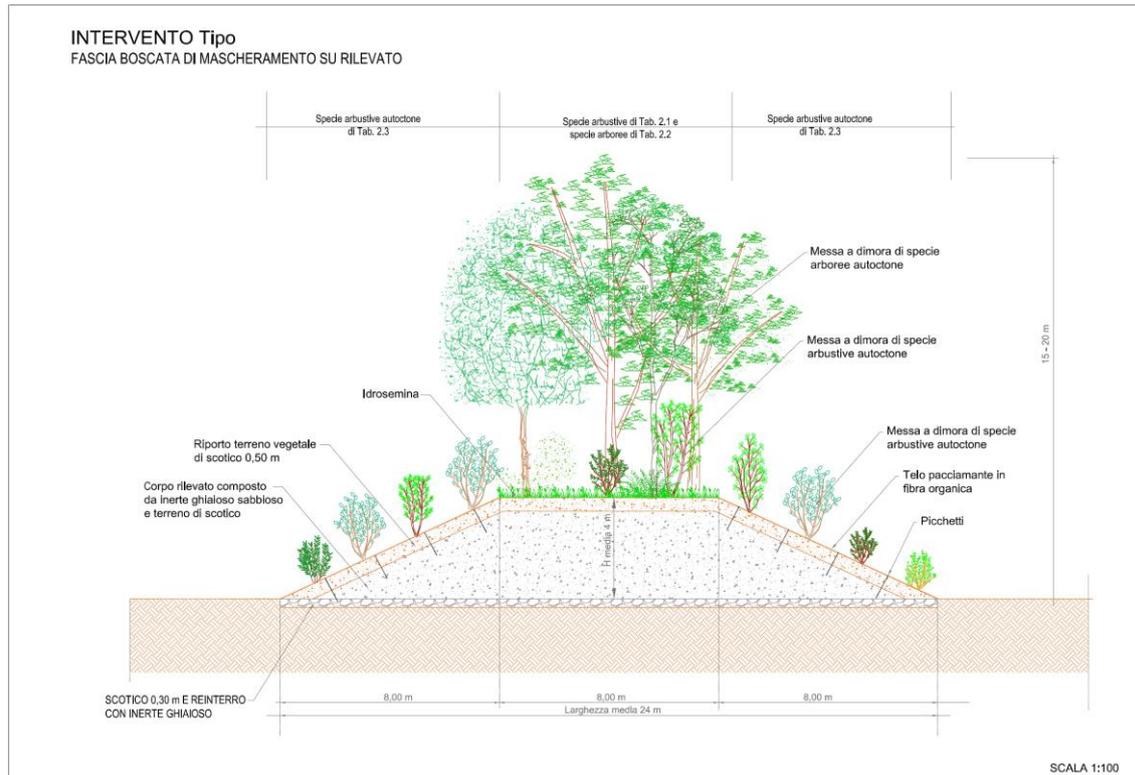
Schema planimetrico interventi su rilevato di mascheramento
